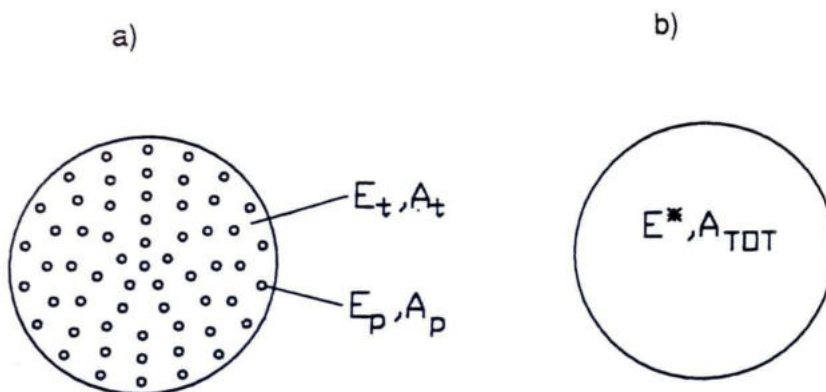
a) GEOMETRIA DI FONDAZIONE SU PALI FITTI
